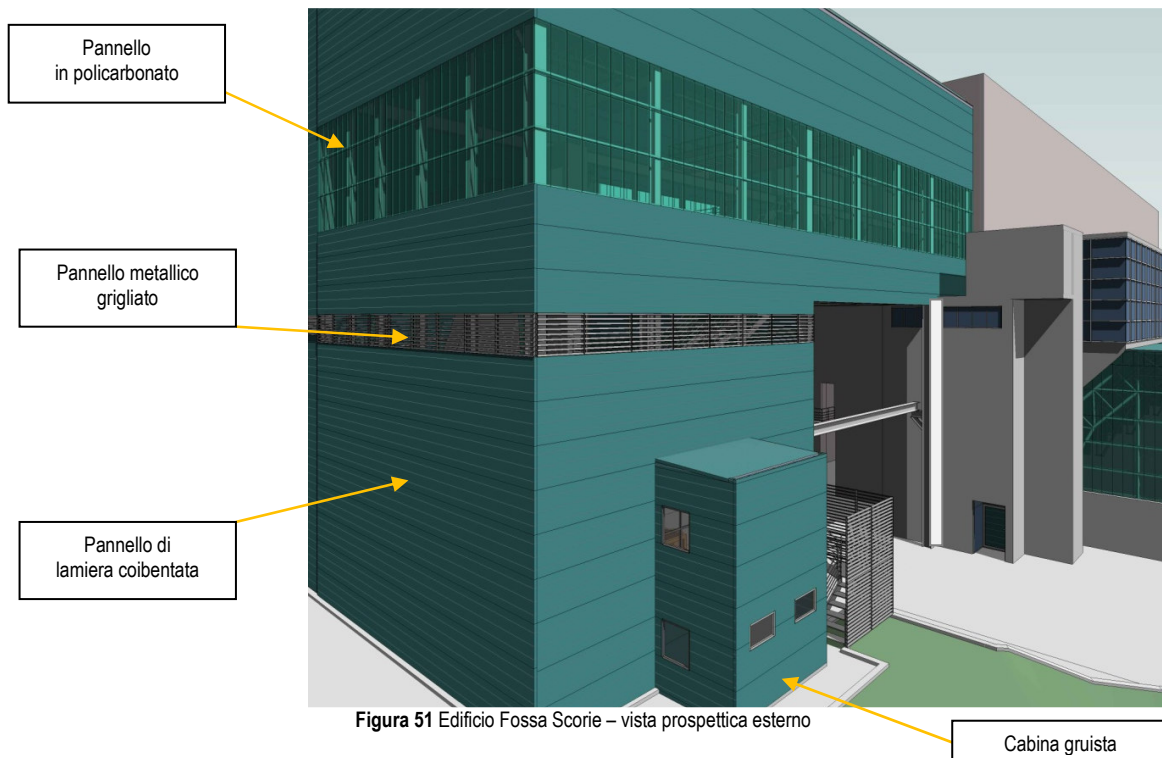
Edificio Fossa Scorie – vista prospettica esterno
